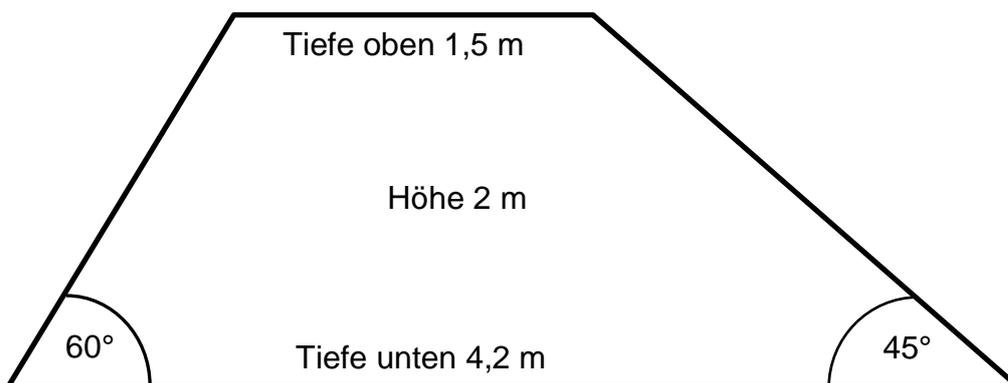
Schematische Darstellung des Walls im Querschnitt ohne Strukturelemente
